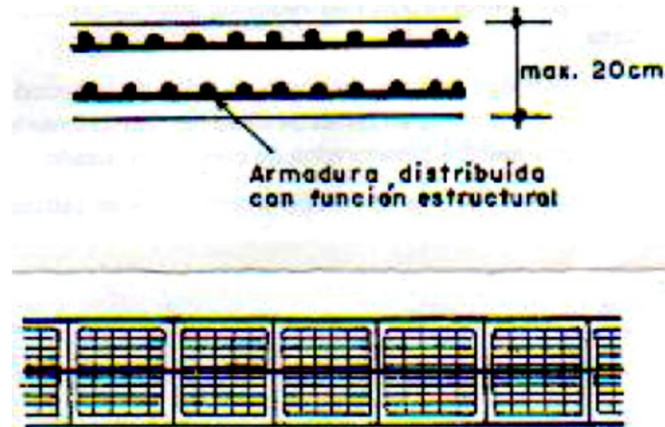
Gráfica de Pavimento Rígido Pre-Esforzado
